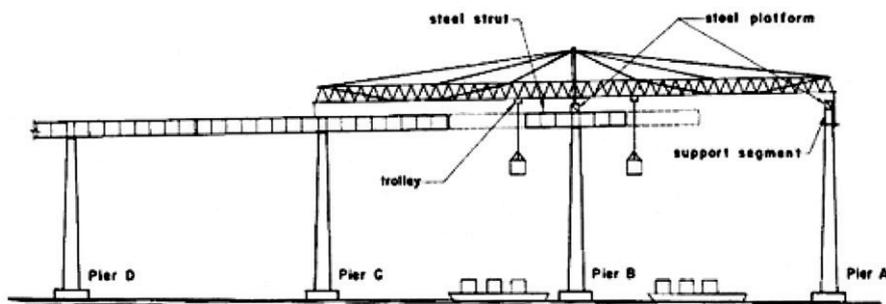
TRELIÇA DE MONTAGEM. FORAM USADAS 4 DELAS NA OBRA
